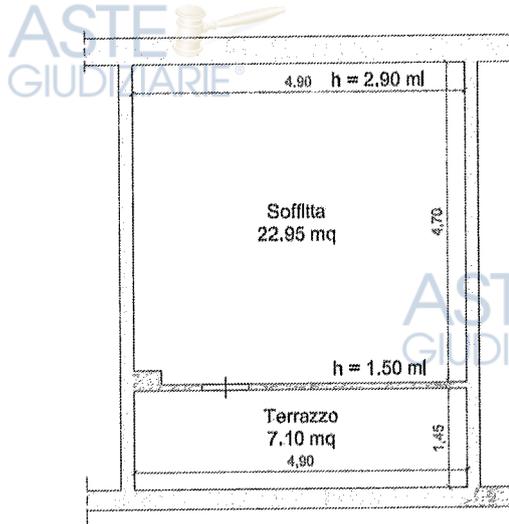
Planimetria Catastale Foglio 47, p.lla 1393, sub 9 – Piano 1
